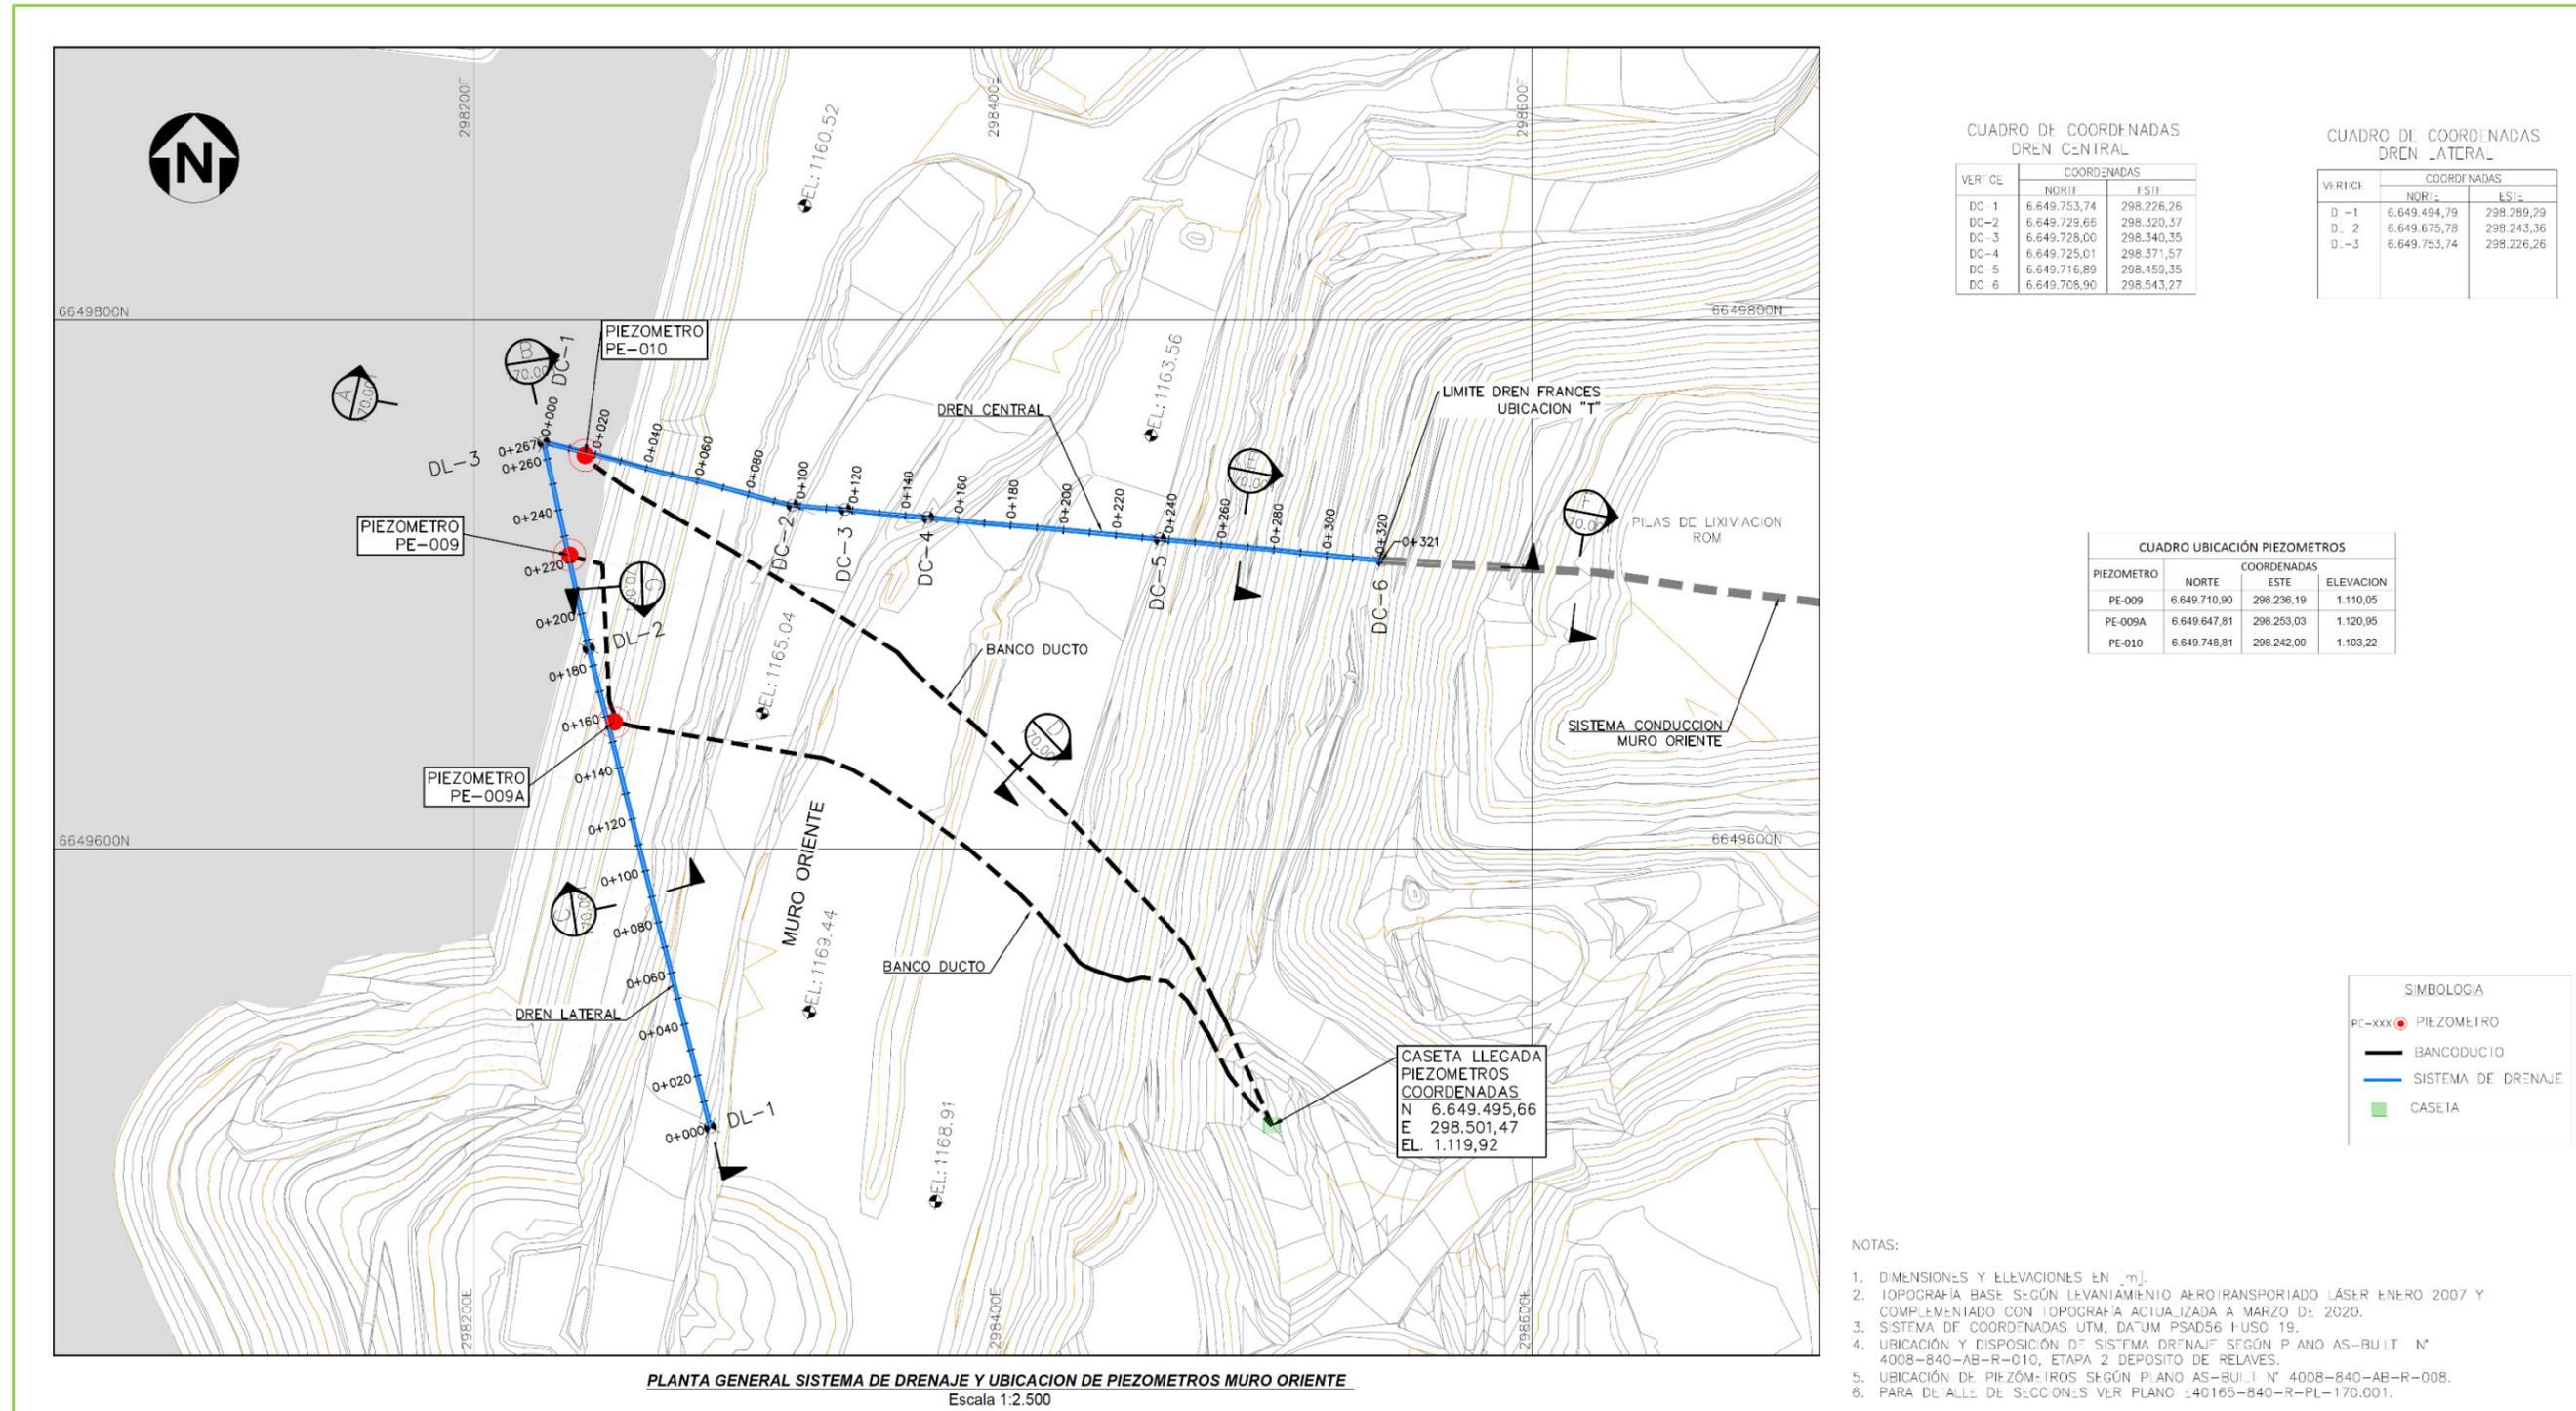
Plano E40165-840-R-PL-171 Sistema de Drenaje y Disposición de Piezómetros Cuerda Vibrante MO(S) Planta y Perfiles (2020.03.31).
